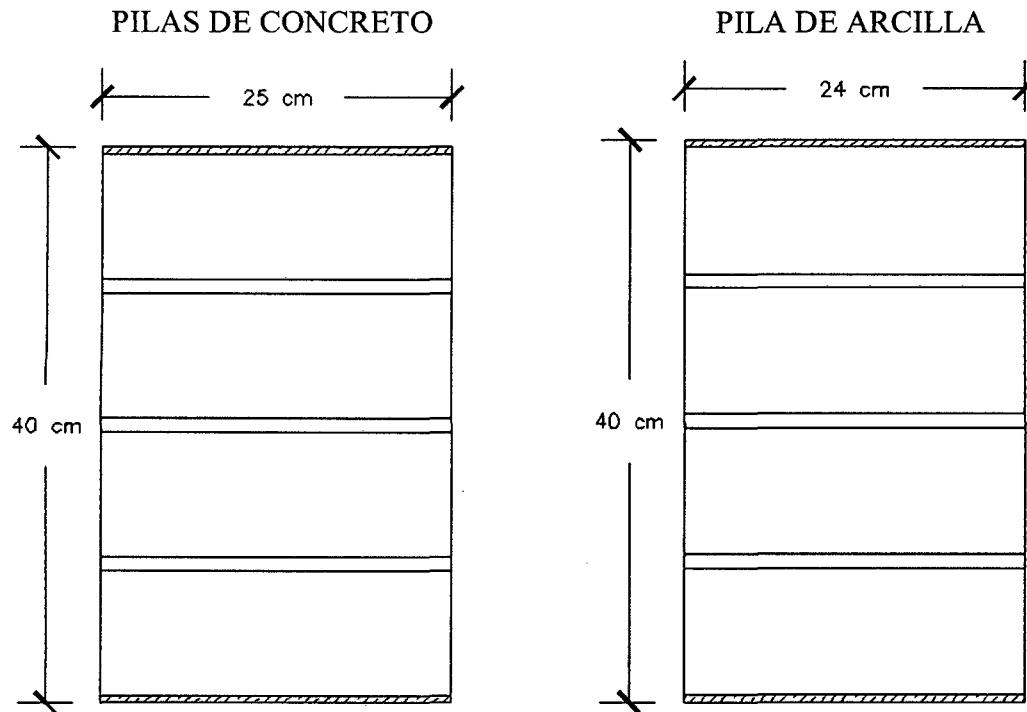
Geometría típica de las pilas de concreto y pilas de arcilla, cada pila consta con un capping de yeso de 0.5 cm de espesor y 1 cm de junta de mortero.
